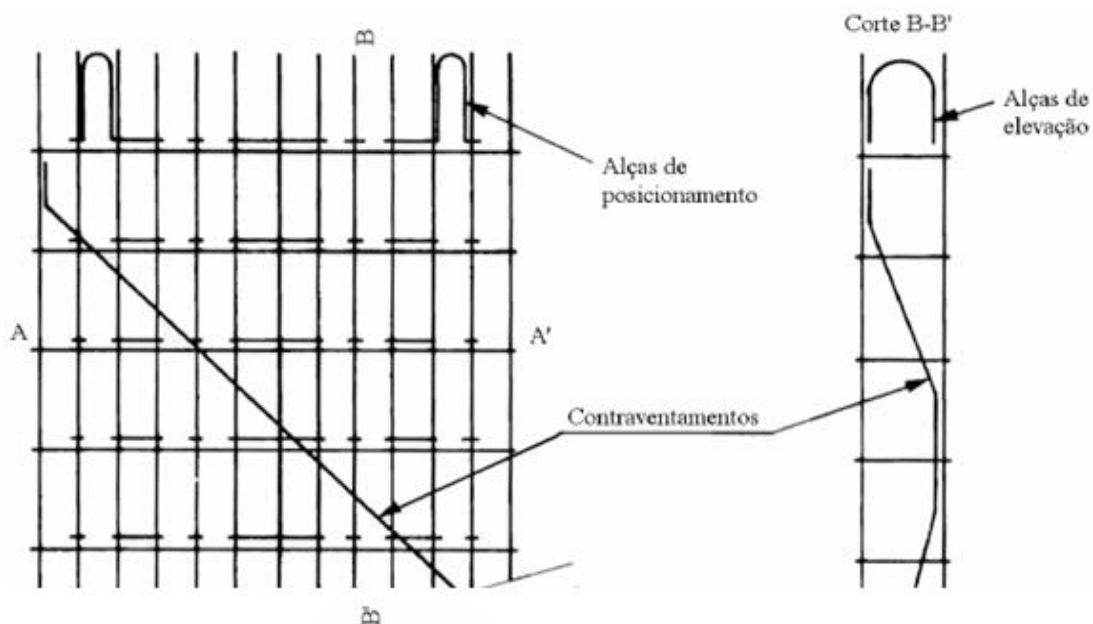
Pormenorização longitudinal tipo de uma parede moldada (Sousa, et al., 2006)
